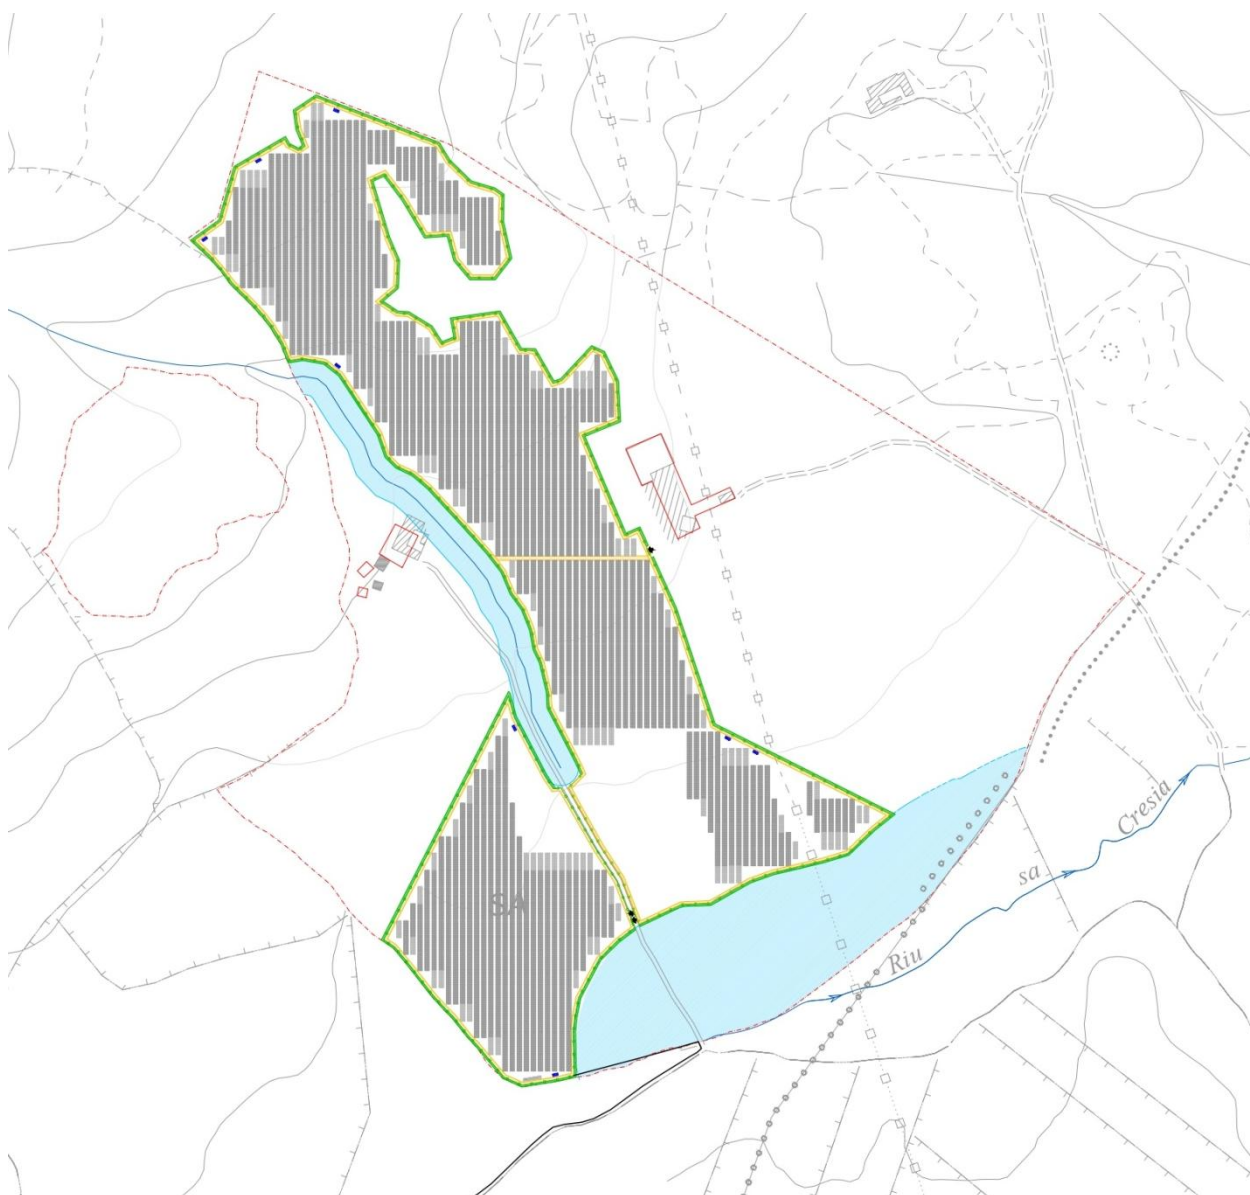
Planimetria layout impianto con indicazione delle fasce di rispetto fluviali.
